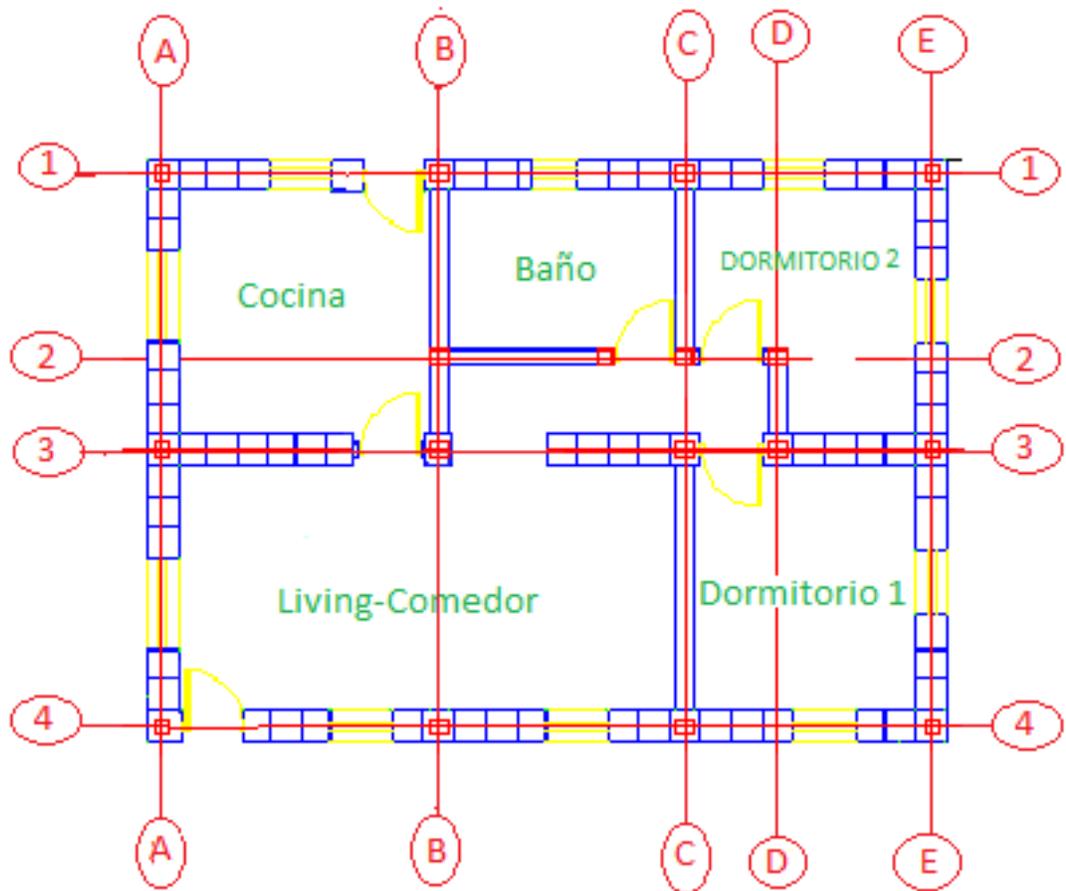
Planta estructural. Fuente: Elaboración propia.
